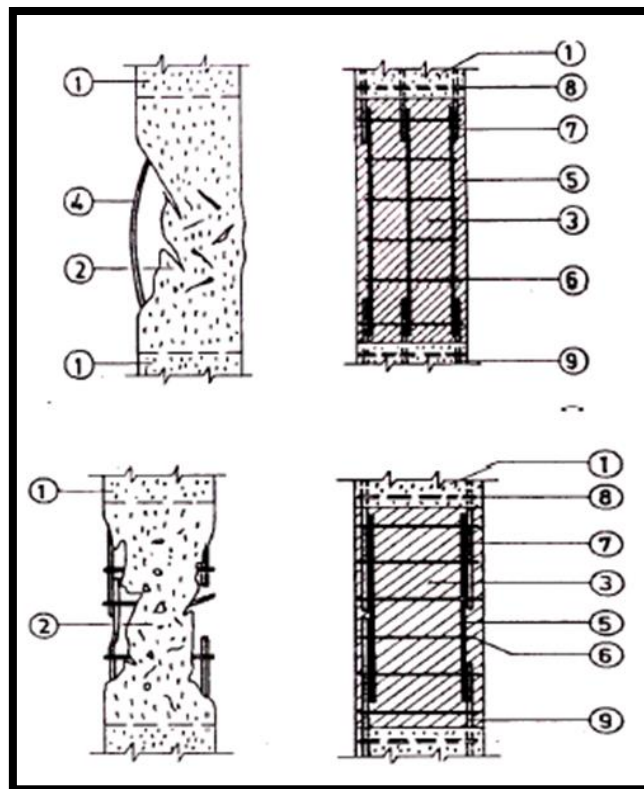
Renforcement avec ajout d'armatures (SEKHRI KHADIDJA, 2024)
